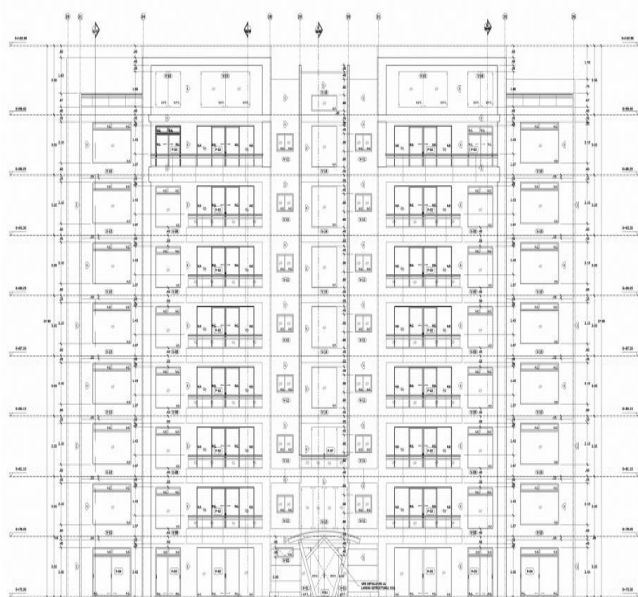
Fachada principal T.Velarde. Fuente: Planos arquitectónicos Proyecto Torres de Velarde
